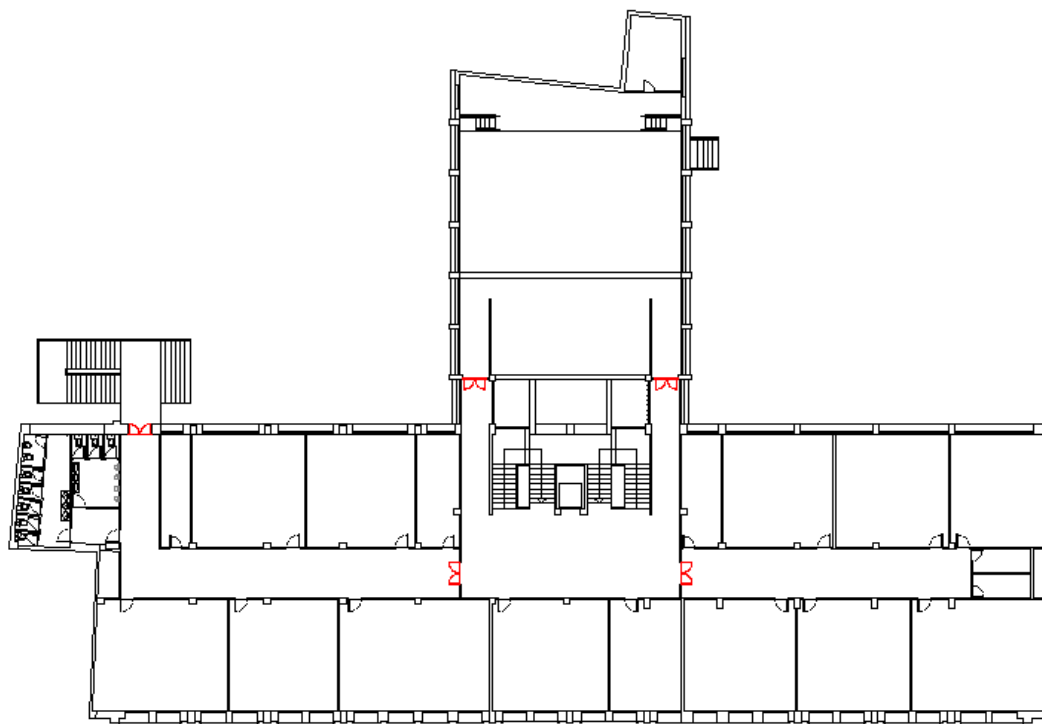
Puertas situadas en recorrido de evacuación en planta primera. Fuente: Elaboración propia.
